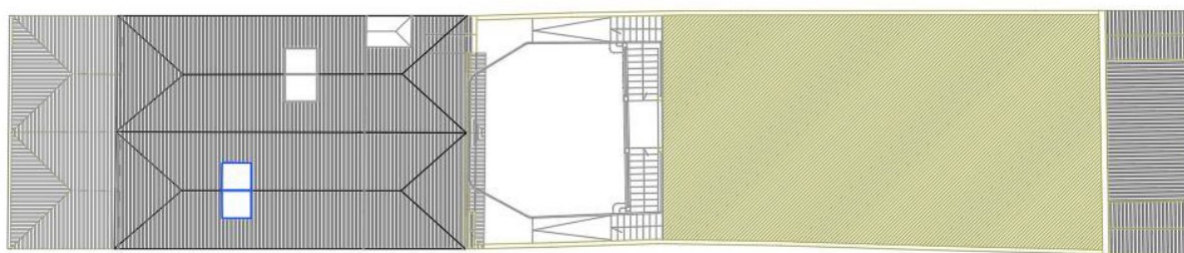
Planta de arquitetura original da cobertura (sem escala)
